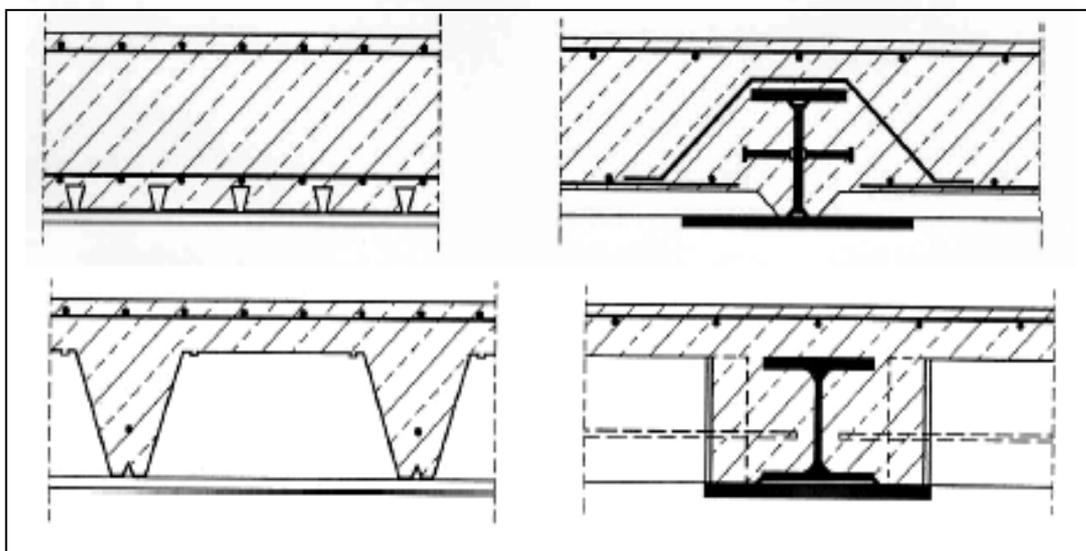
Stahlblechverbunddecke als Flachdecke, Ausführungsvarianten, aus [9]
